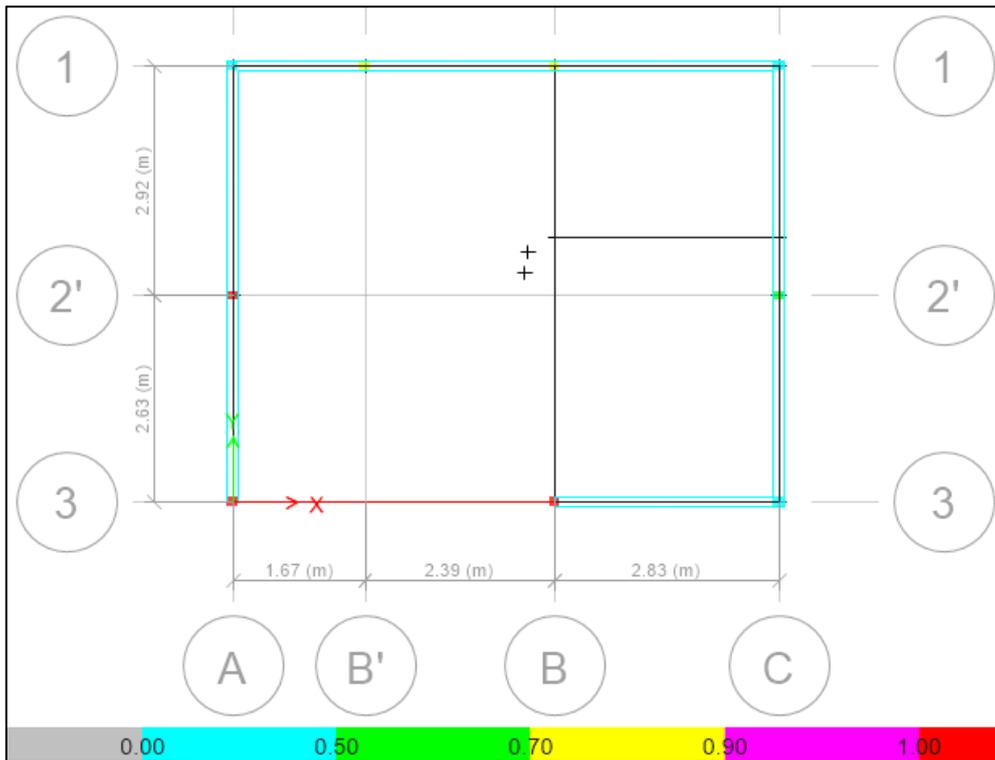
Comprobación de elementos estructurales de concreto armado en etabs
